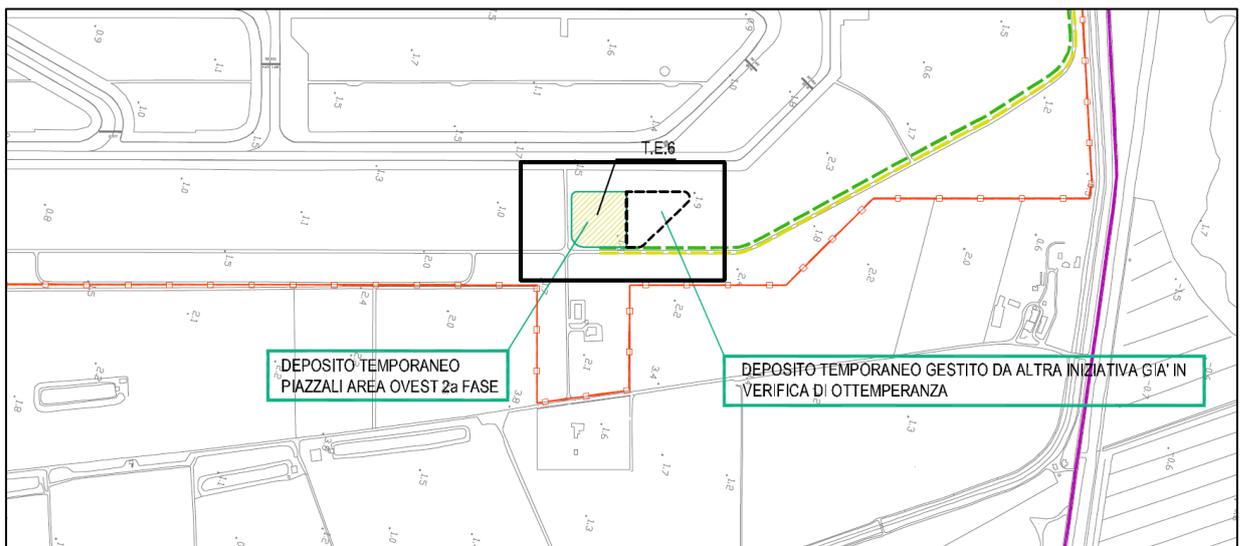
Stralcio planimetrico con l'evidenza del deposito
